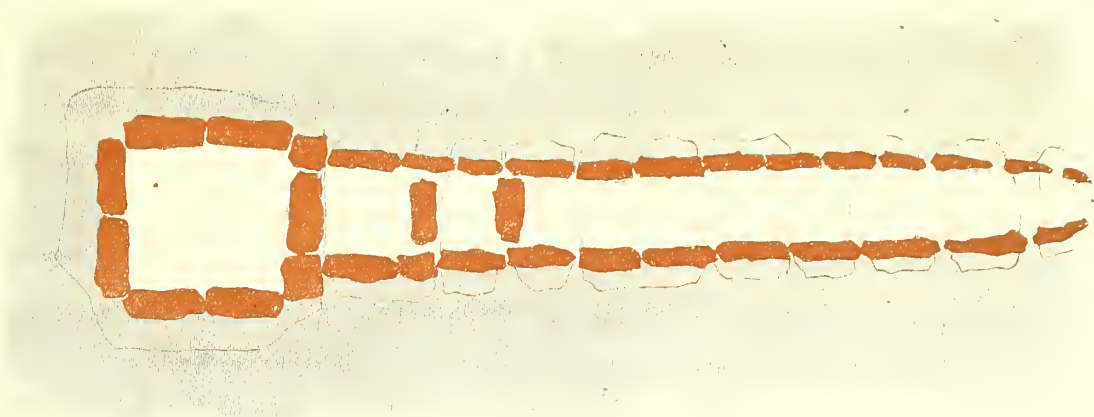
PLANTA DEL DOLMEN DE GAVR'INIS
